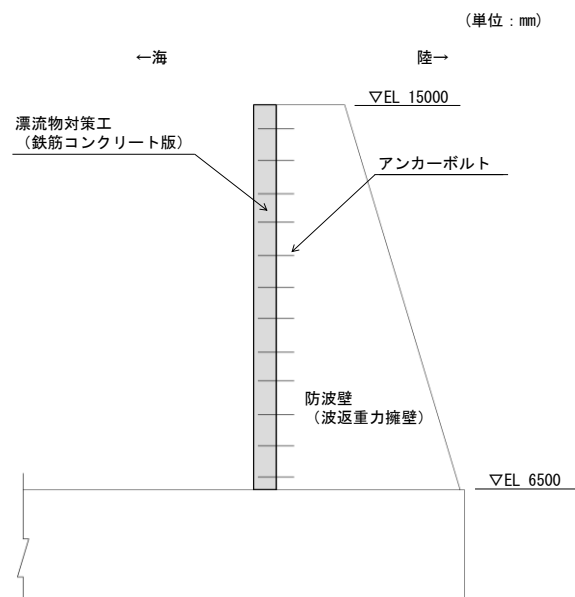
漂流物対策工（鉄筋コンクリート版）の評価対象部位
